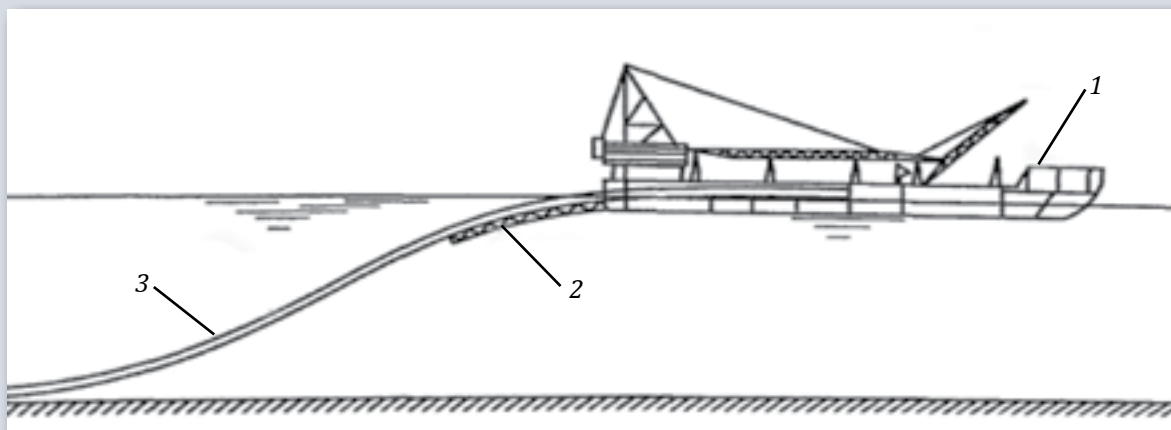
Укладка подводного трубопровода на дно моря S-методом: 1 – трубоукладочное судно; 2 – стингер; 3 – трубопровод
